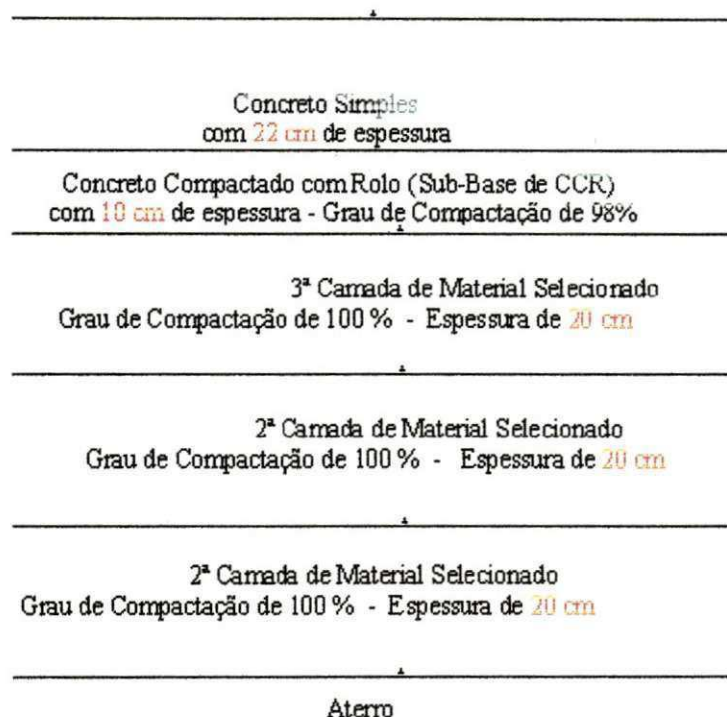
estrutura do pavimento da BR 101, lote 06 divisa PB/PE – Entrada PE-035.
